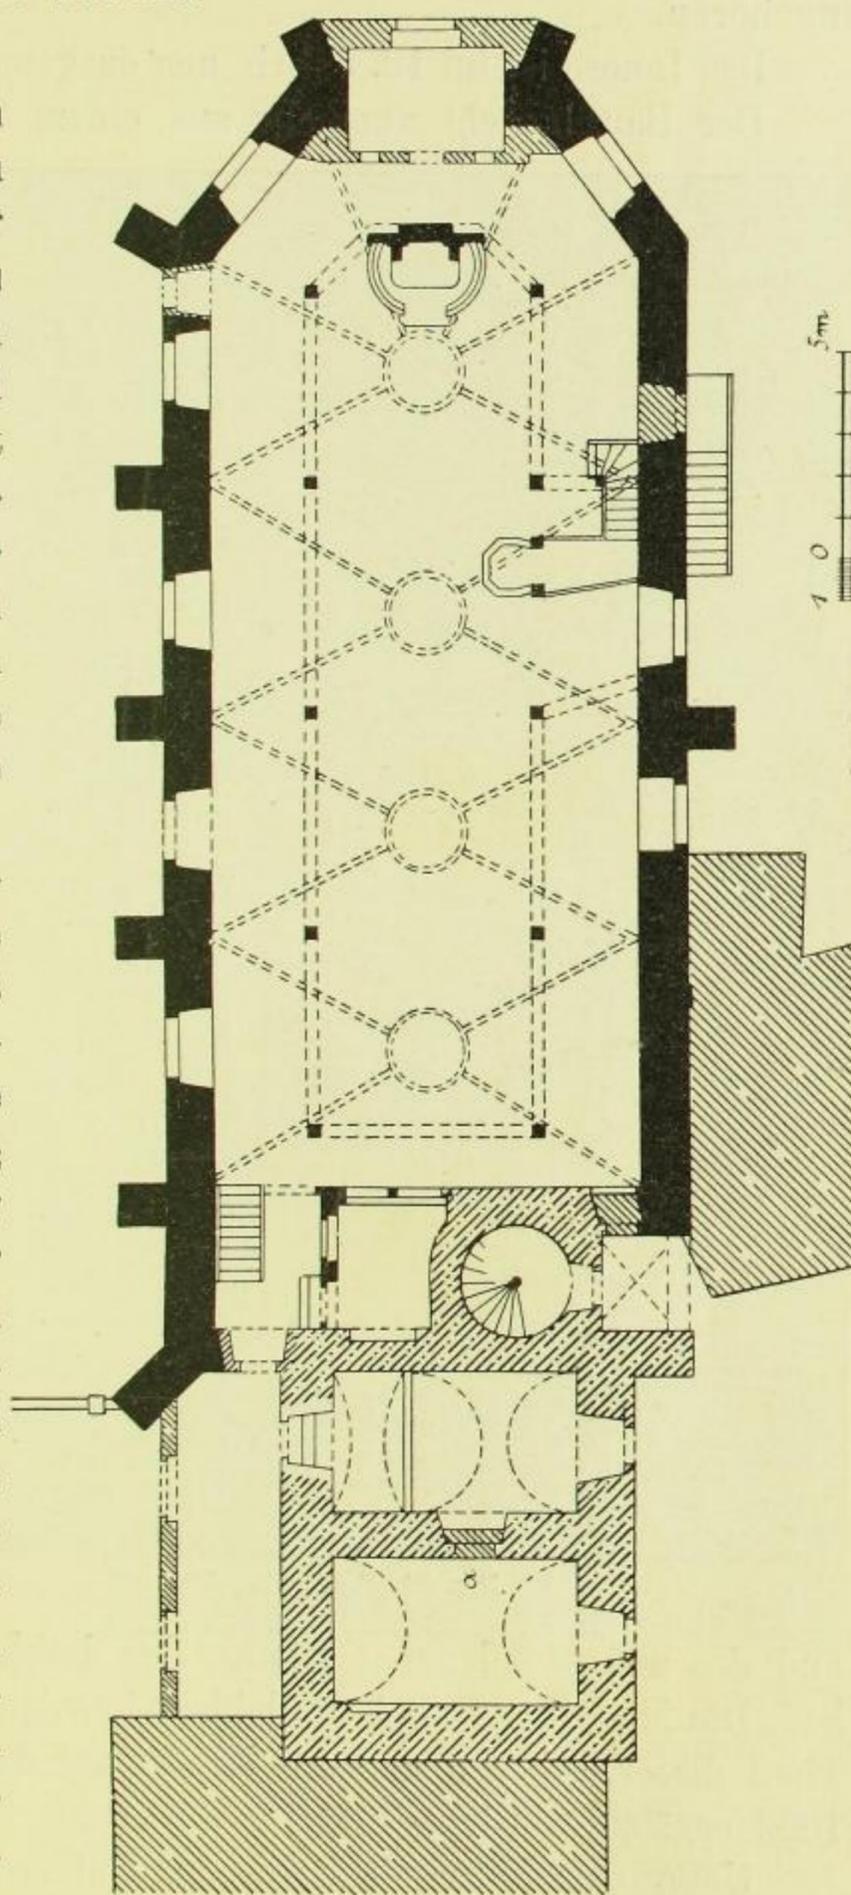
Lockwitz, Grundriss der Kirche.
